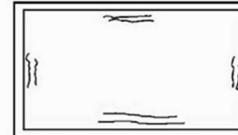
Fissuração por esmagamento do concreto, devido à reduzida espessura da laje. As fissuras surgem na face inferior, por deficiência diante dos momentos negativos.
